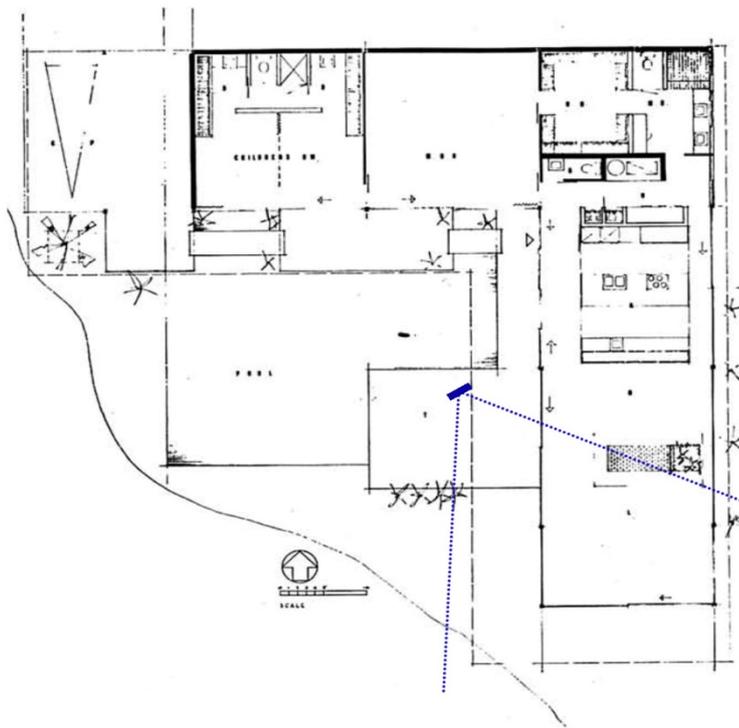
\_ Plano Case Study House n° 22 y posición aproximada de la cámara.
